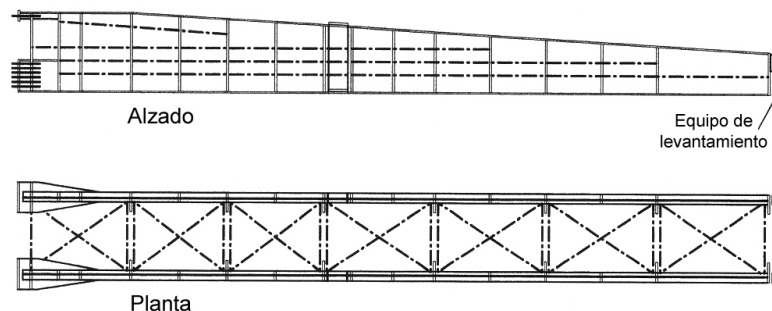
Alzado y planta de un pico de lanzamiento <sup>[F22 y elaboración propia]</sup>.
